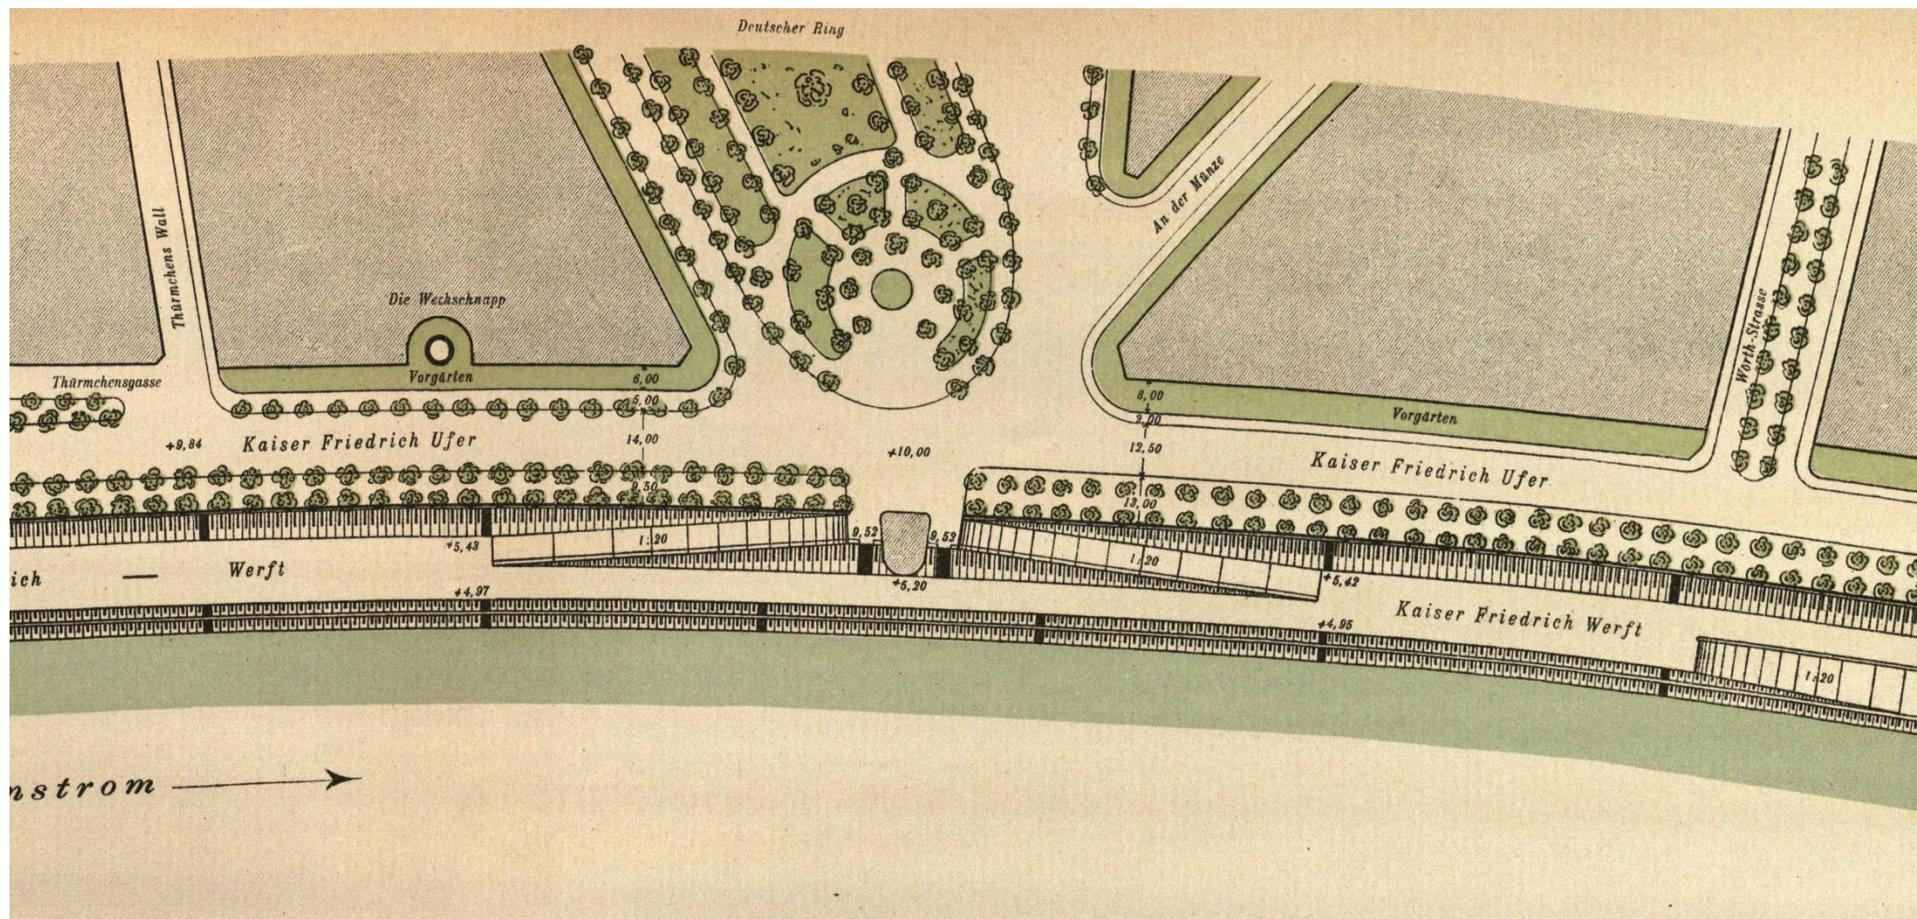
Lageplan der Werft- und Hafen-Anlagen nördlich der Schiffbrücke nach der Vollendung (Ausschnitt). Einmündung des Deutschen Rings in das Kaiser-Friedrich-Ufer, Planungsstand im Jahre 1898. In den Grünanlagen der Ringstraße das Rondell, das als Standort für das Denkmal Kaiser Friedrichs III. vorgesehen war. In der Achse der Ringstraße die Kaponniere. Links der anstelle der Thürmchensbastion geplante Baublock mit dem Kunibertstürmchen, rechts die Bebauung des nördlichen Stadterweiterungsgebietes.
